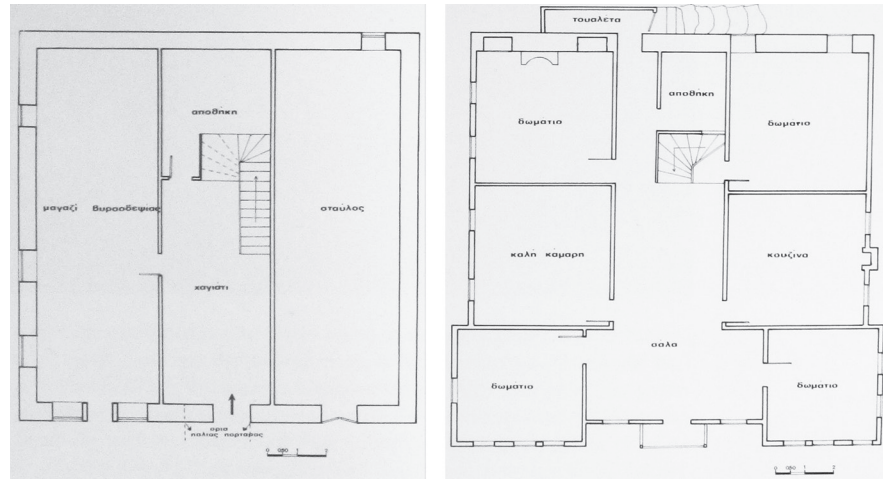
Grundriss Erdgeschoss und Obergeschoss mit sechs Zimmern eines Wohnhauses in Arneia, Eckzimmer mit Erkern und Erweiterung des zentralen Raumes in den Straßenraum durch einen Balkon (aus: Arneia 1990:16)
